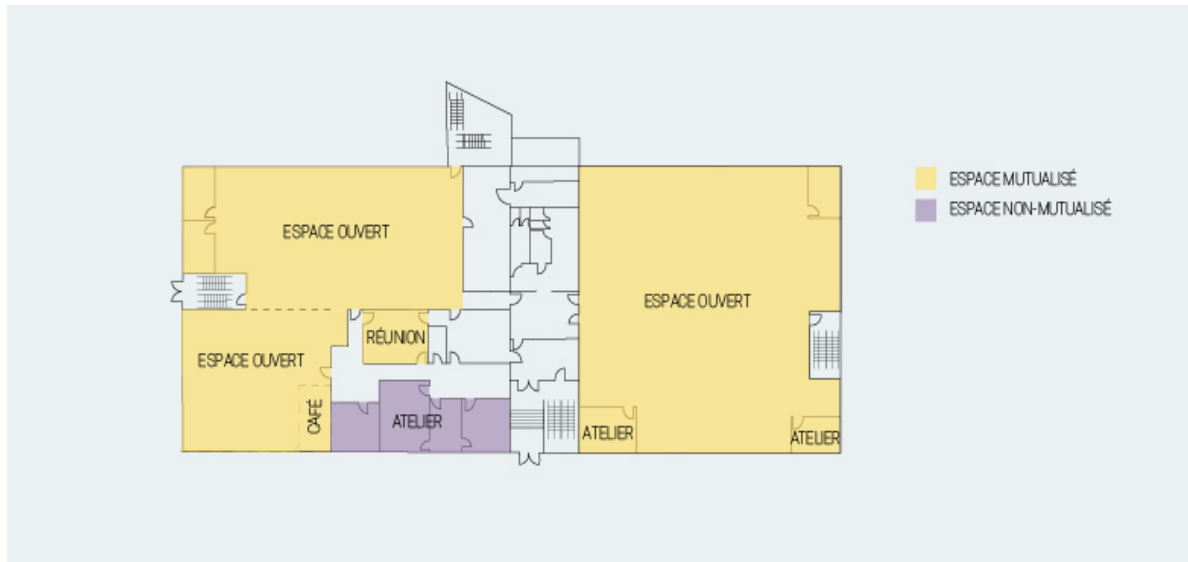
Exemple de mutualisation des espaces du bâtiment 9515, Rue Saint-Hubert. Rez-de-Chaussée.
